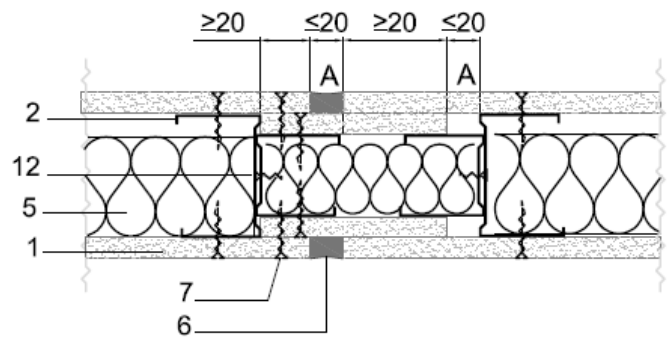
Junta de dilatación vertical (sección horizontal).
